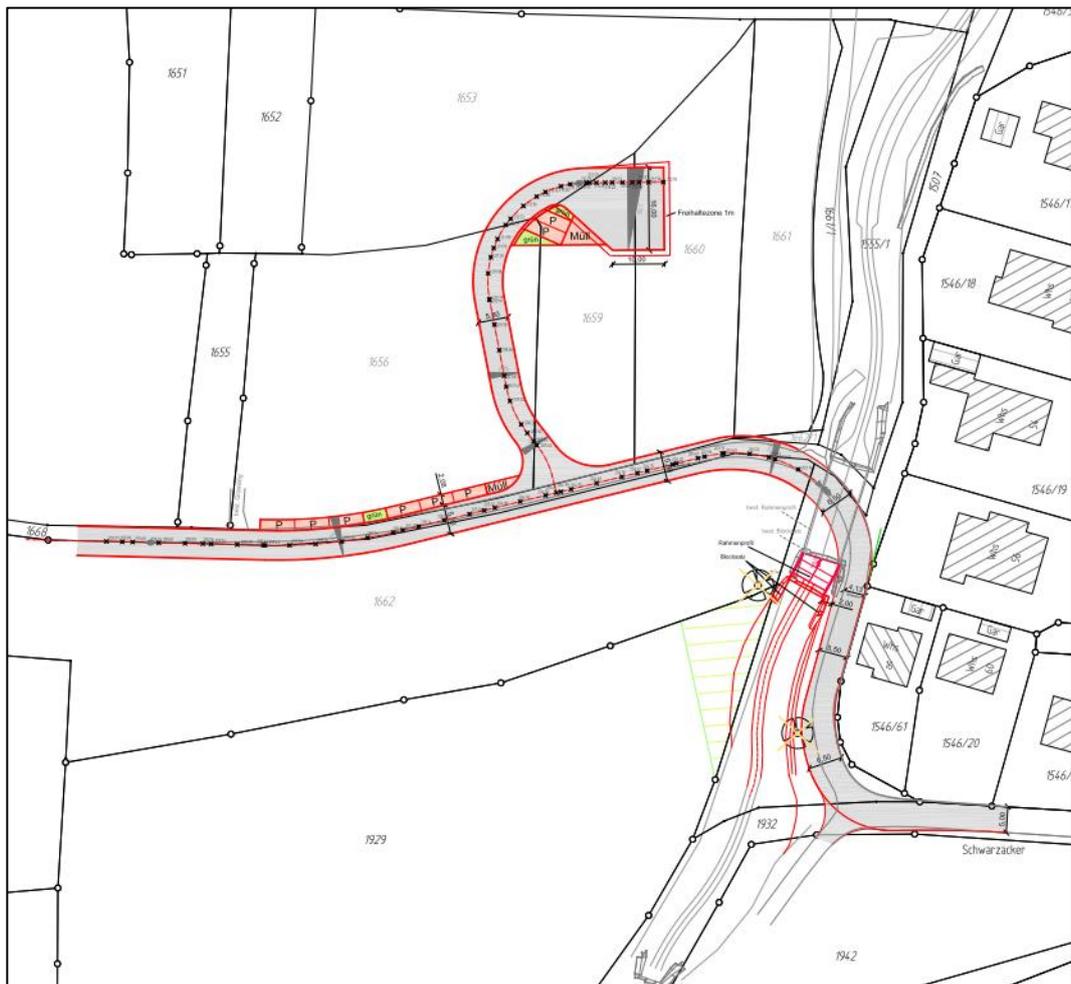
Vorentwurf Lageplan Straßenbau, Stand 21.12.2020, Kreistiefbauamt Landratsamt Hohenlohekreis
